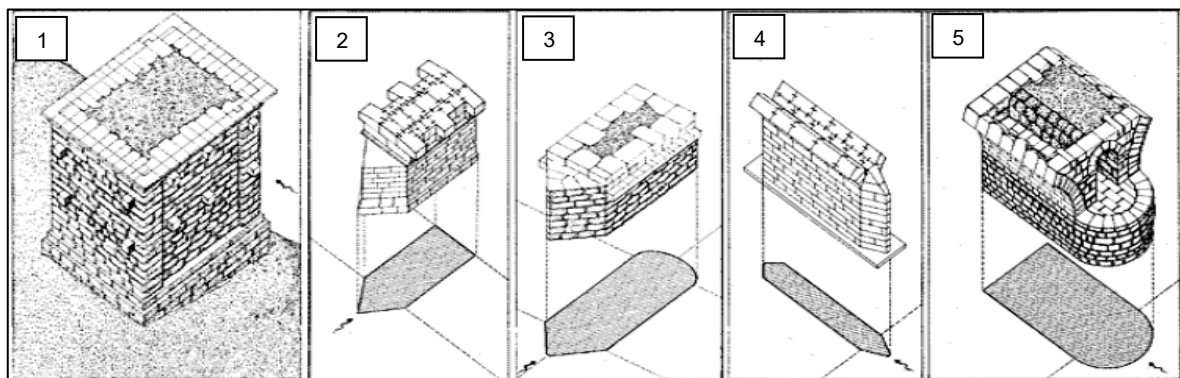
Pianta e rappresentazione prospettica dall'alto di cinque tipi di pile. (Fonte: Galiazzo, 2004)
